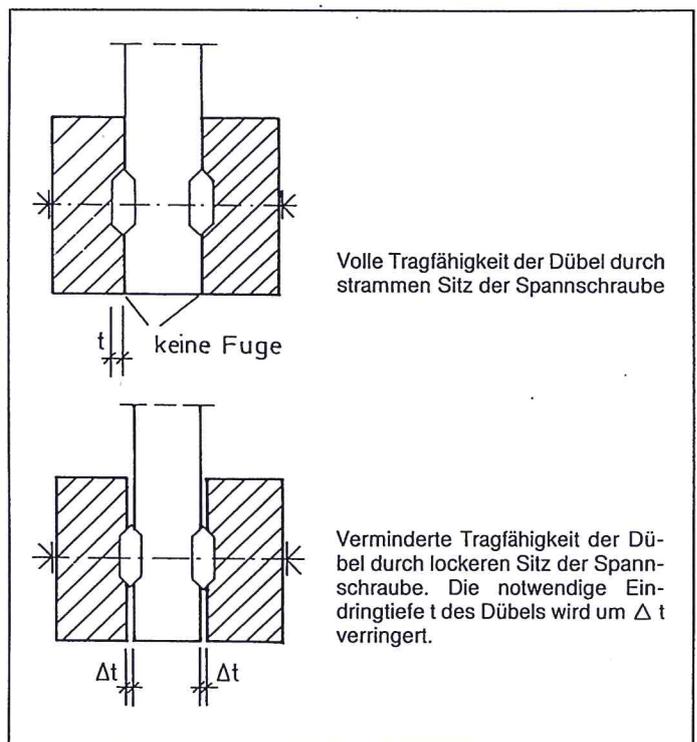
Häufige Schäden an Fachwerkbindern mit Dübelverbindungen
